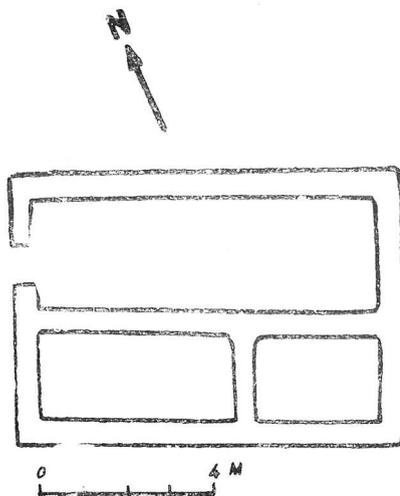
Los Millares*. Interpretación de la planta de la casa n.º 1 sobre croquis de Siret.
